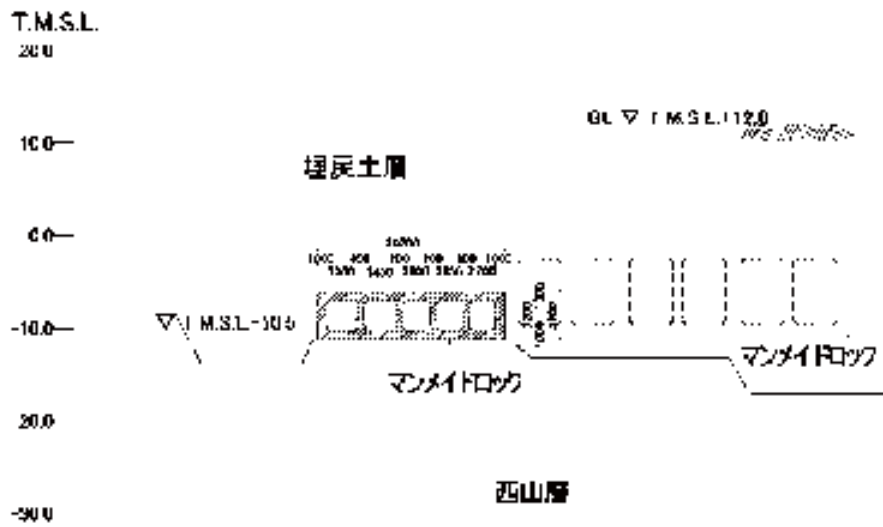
補機冷却用海水取水路（南側）断面図（C-C断面）
